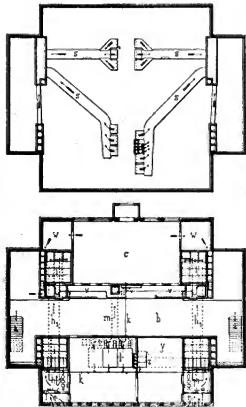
27. Z. A. Heizung und Ventilation einer Schule in New Haven.
